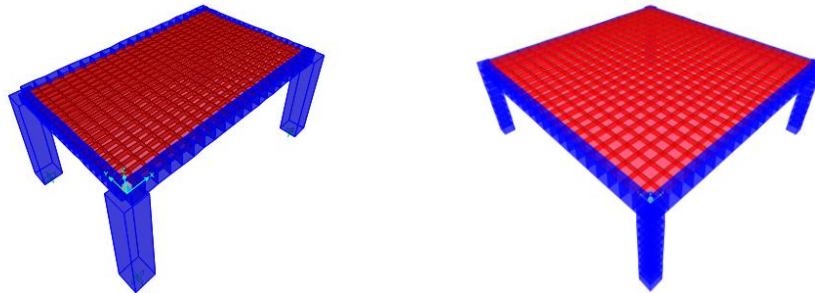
Modelos numéricos de losas de concreto reforzado apoyadas sobre vigas.
